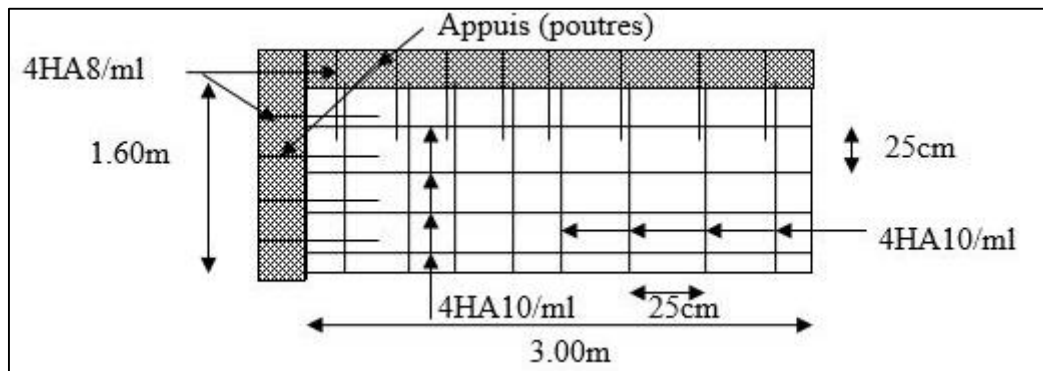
Schéma de ferrailage de la dalle sur 2 appuis .
